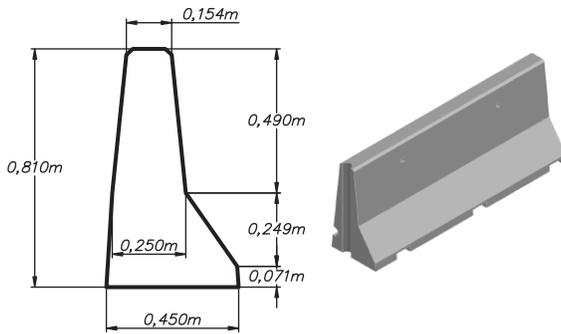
Sección y perspectiva de las barreras de concreto centrales
